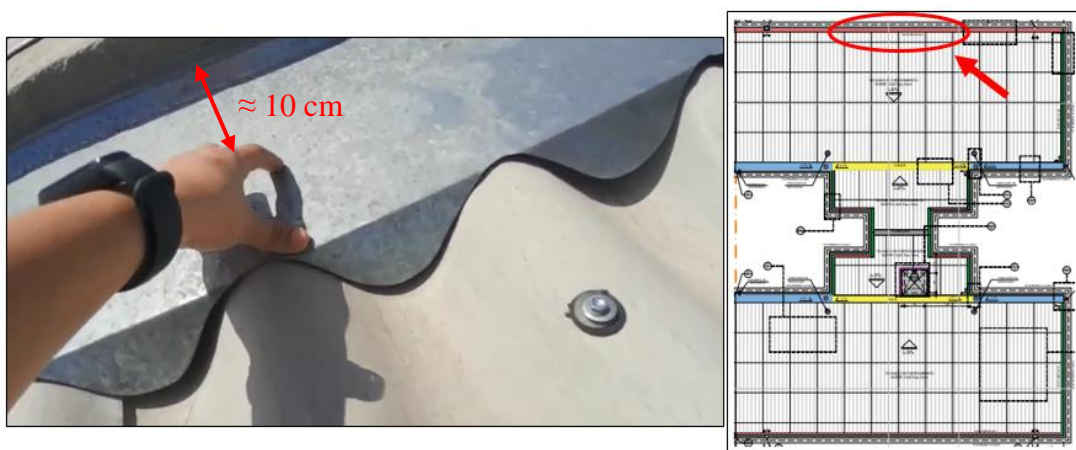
Fissuras na platibanda e no selamento do rufo
